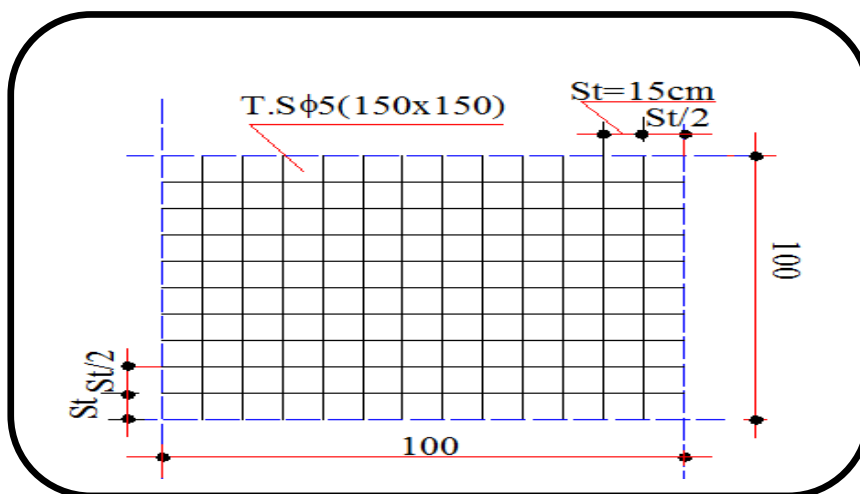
Disposition constructive des armatures de la dalle de compression
